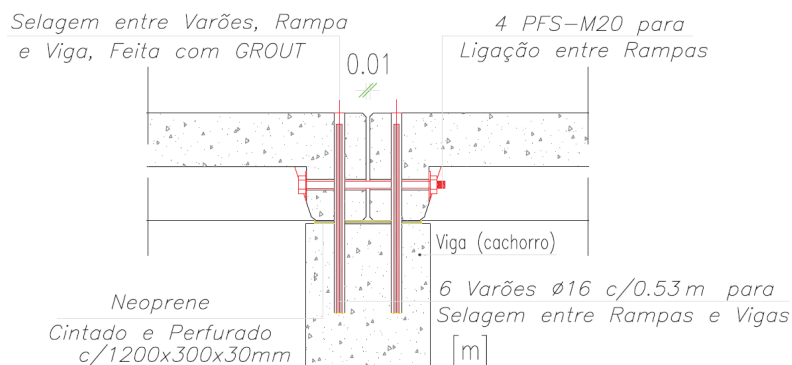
Pormenor de selagem entre a viga cachorro e as rampas [33].
